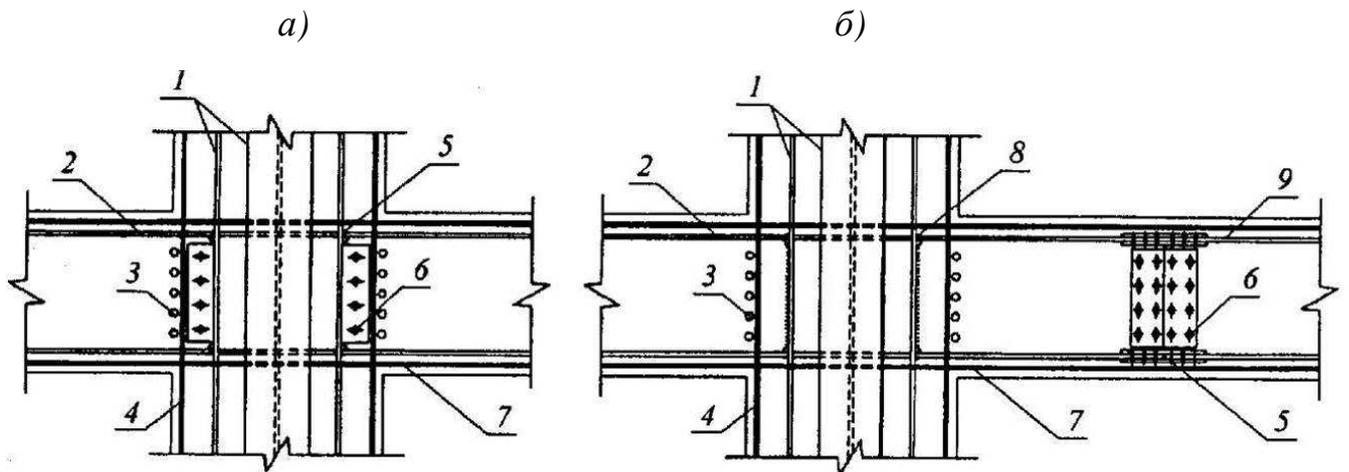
Монтажные узлы соединения стальных профилей элементов жесткого армирования сталежелезобетонных конструкций колонн и балок для каркаса высотных зданий: *а* – сварное соединение профилей в условиях строительной площадки; *б* – болтовое соединение профилей в условиях строительной площадки; 1 – стальной профиль в конструкции колонны; 2 – стальной профиль в конструкции балки; 3 – сквозные отверстия; 4 – рабочая арматура из стержневой арматуры в колонне; 5 – монтажный электросварной шов; 6 – высокопрочные болты; 7 – рабочая арматура из стержневой арматуры в балке; 8 – электросварной шов, выполненный на заводе-изготовителе; 9 – фрагмент пролетной части жесткой арматуры из прокатного профиля
